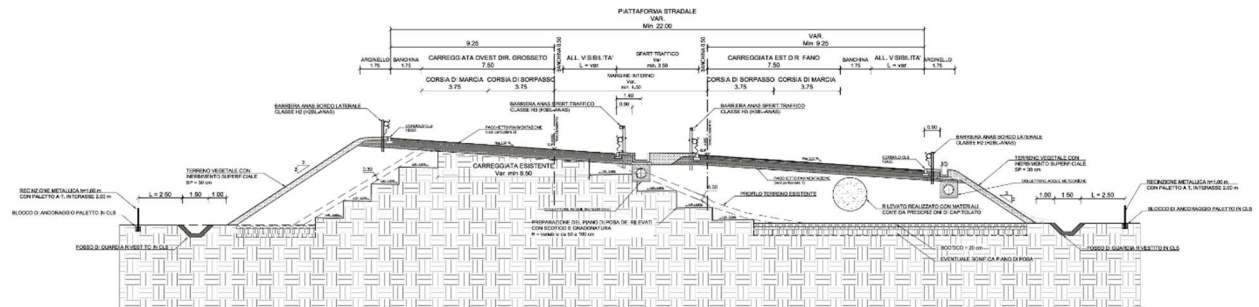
Sezione tipo in rilevato in curva con ammassamento
